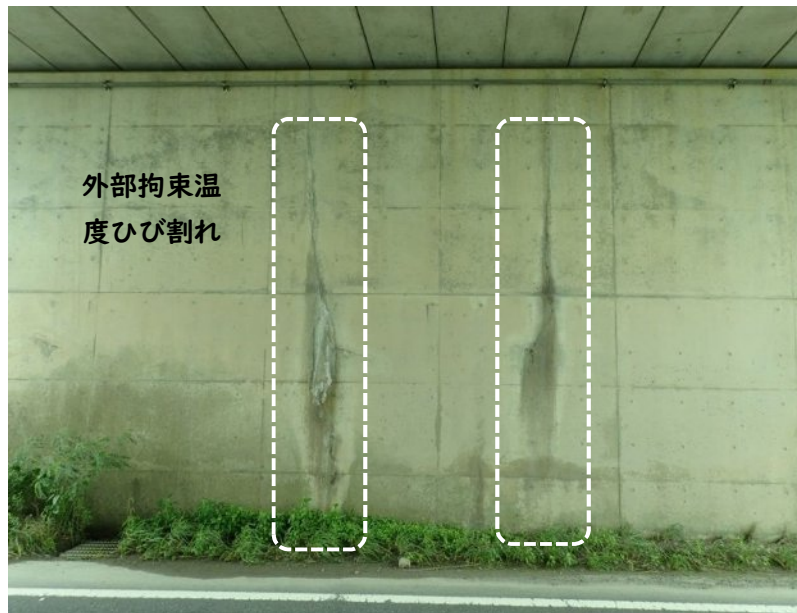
外部拘束温度ひび割れ（貫通ひび割れ）
